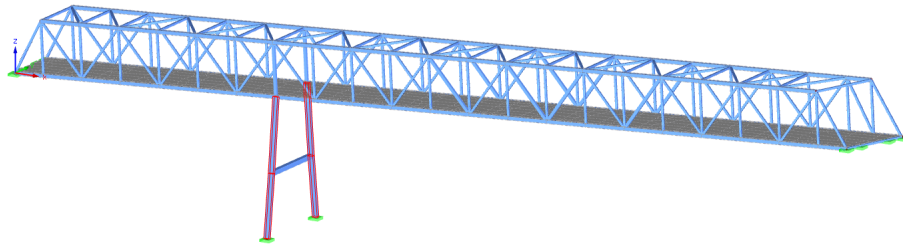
Vista del modelo con la Sección 5 (montantes del apoyo intermedio).
